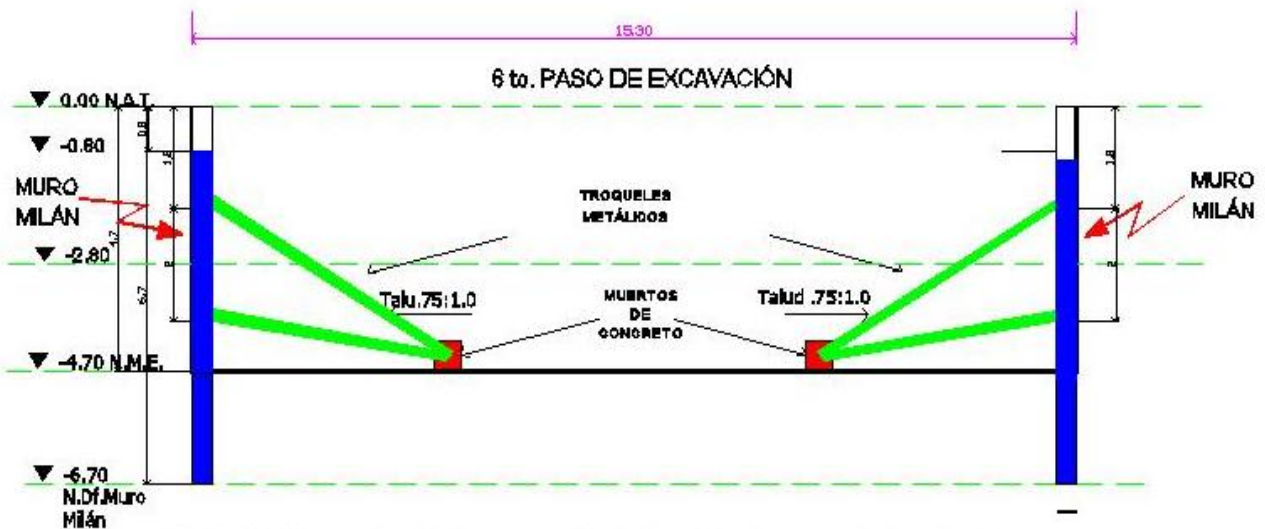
FIGURA ) Se recortará la berma perimetral hasta alcanzar el nivel de máxima excavación y se colocará la segunda línea de troqueles.
